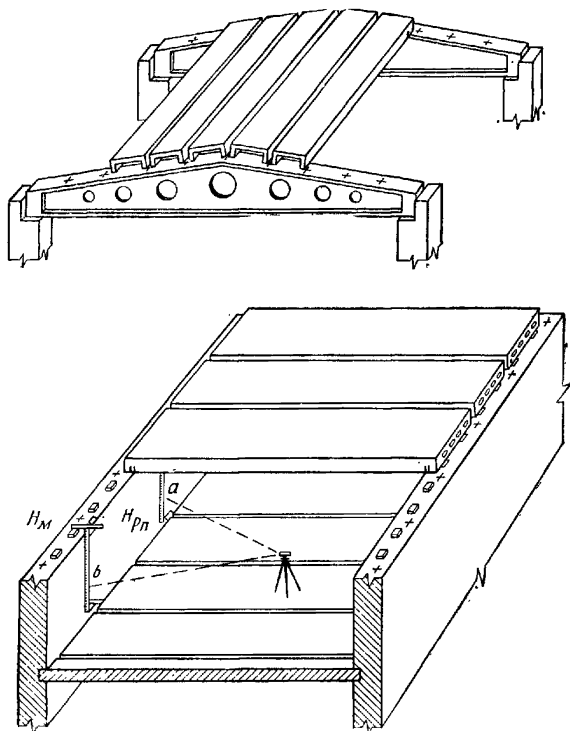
Разбивка и выверка плит покрытия и перекрытия
